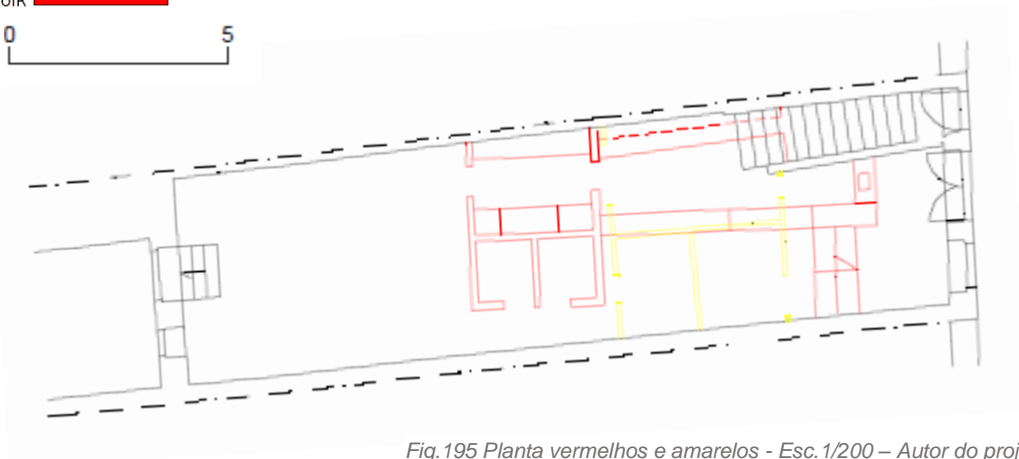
Planta vermelhos e amarelos - Esc. 1/200 – Autor do projeto
